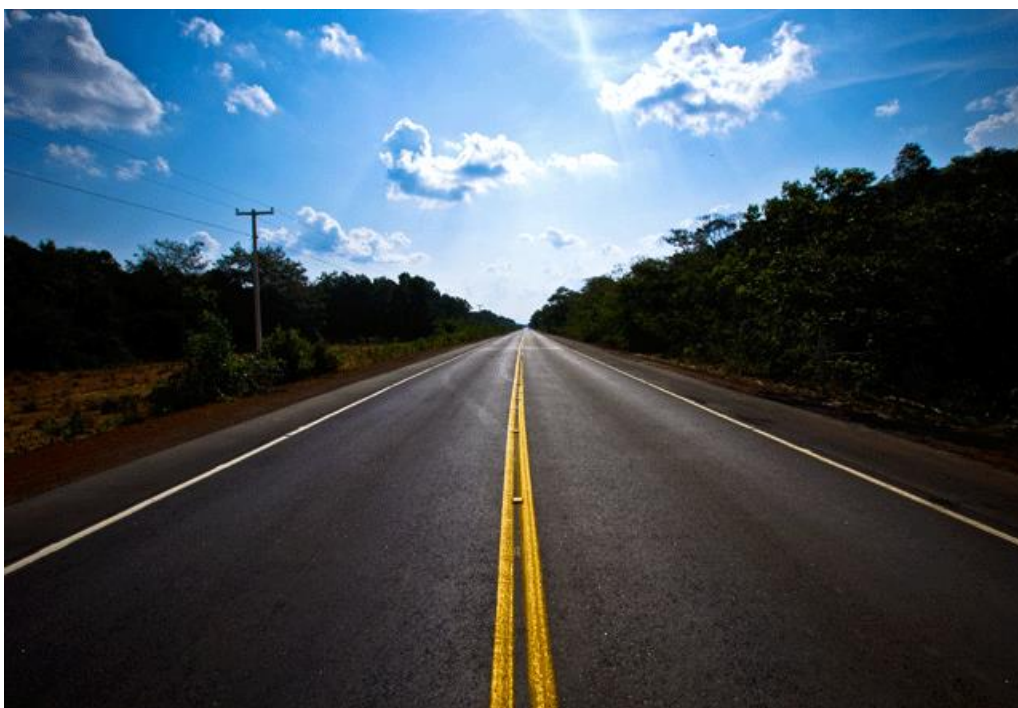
Obras na BR – 163. Fonte: Arquivo do 5º Batalhão de Engenharia de Construção.
